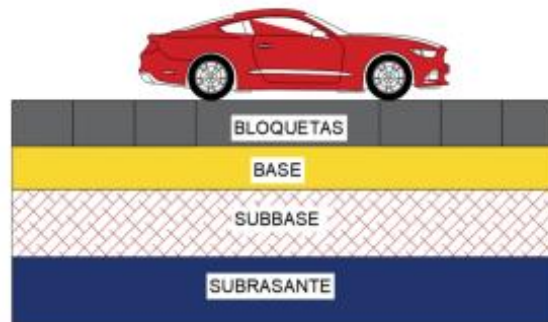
Estructura de Pavimento Mixto (definición 1).
